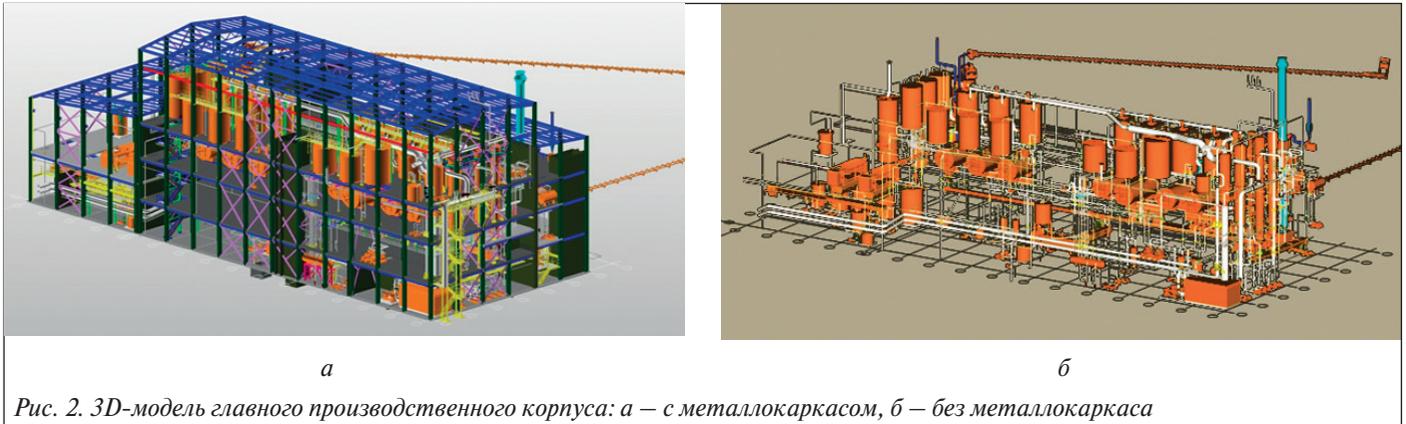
3D-модель главного производственного корпуса: а – с металлокаркасом, б – без металлокаркаса
